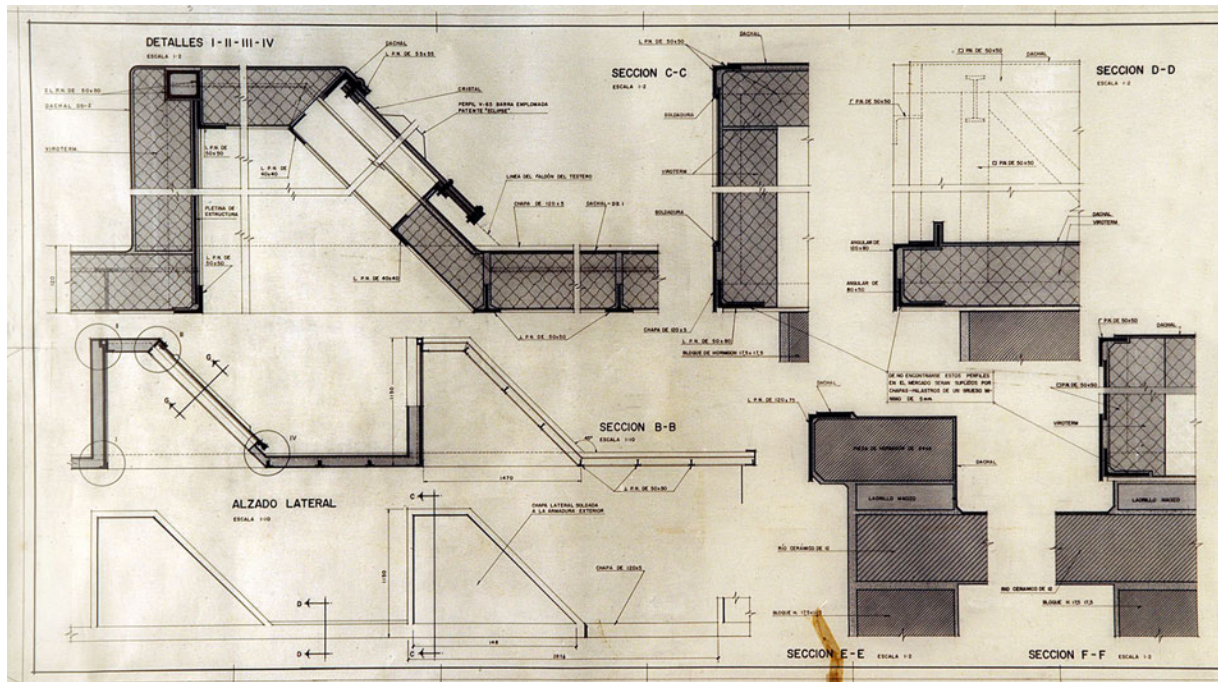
Secciones y detalles constructivos de la cubierta. Imagen: AGUN/201.
